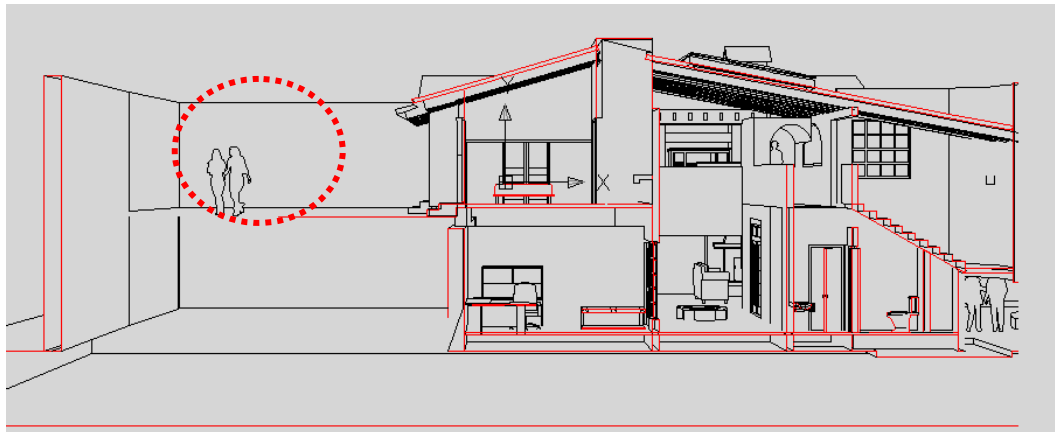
Corte transversal, residencia caso 1, proyecto arquitectónico
